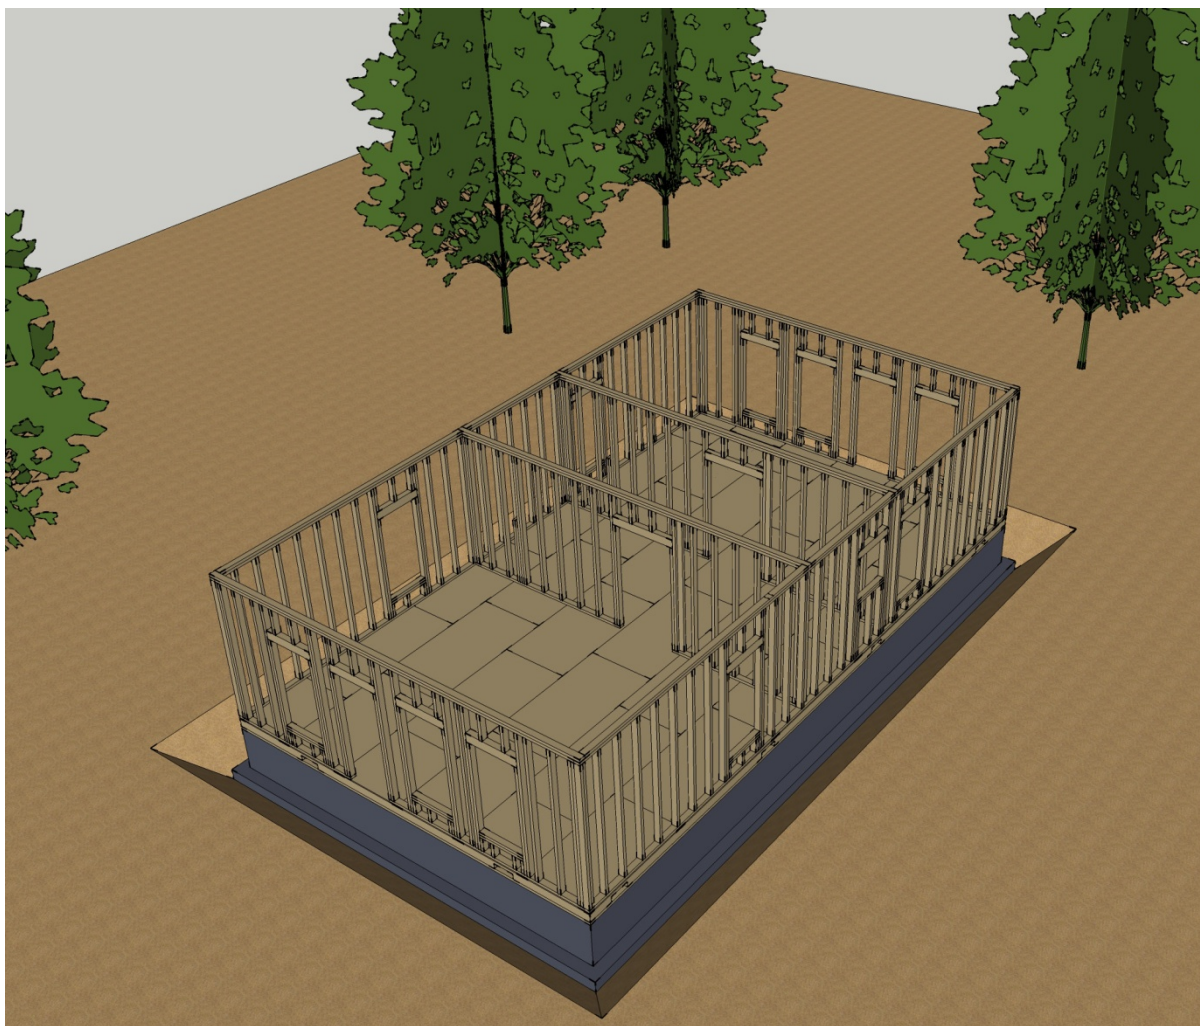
Montagem de paredes interiores transversais (pelo mesmo processo de construção sobre o pavimento) e remoção das escoras e tirantes das paredes exteriores.
